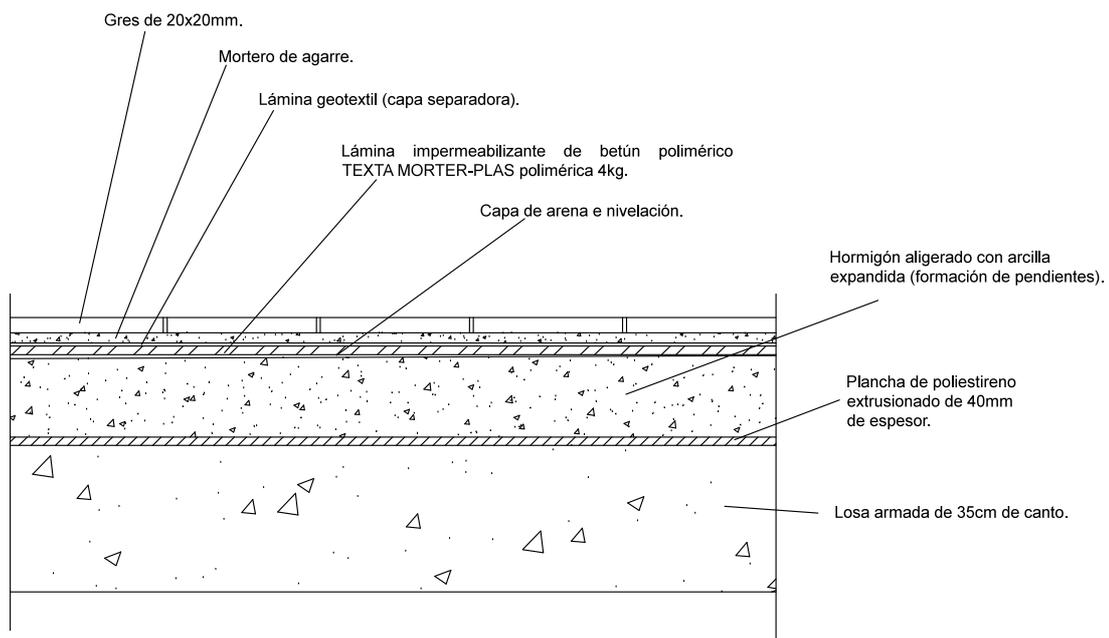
Detalle constructivo cubierta plana transitable con acabado de gres (azotea y patios interiores).
